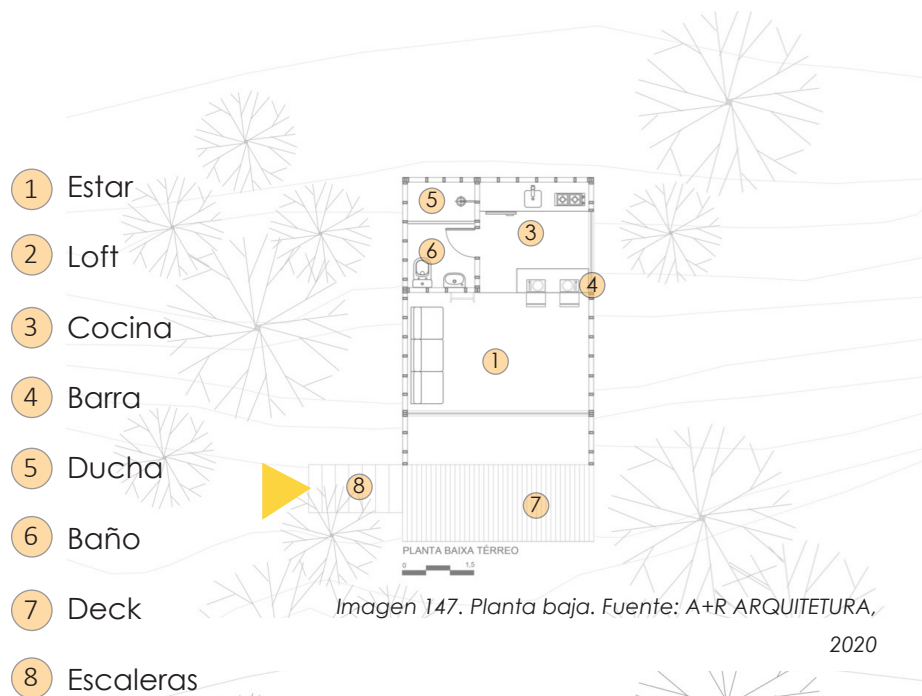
Planta baja. Fuente: A+R ARQUITETURA, 2020
